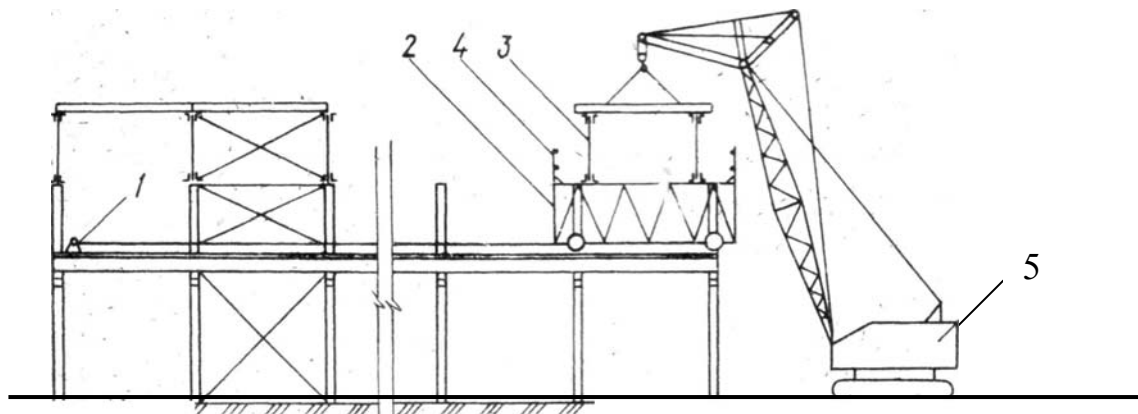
Заміна несучих конструкцій покриття установником мостового типу: 1 – лебідка; 2 – установник; 3 – ферма переопирання (фальш-ферма); 4 – огороження на установнику; 5 – стріловий гусеничний кран
